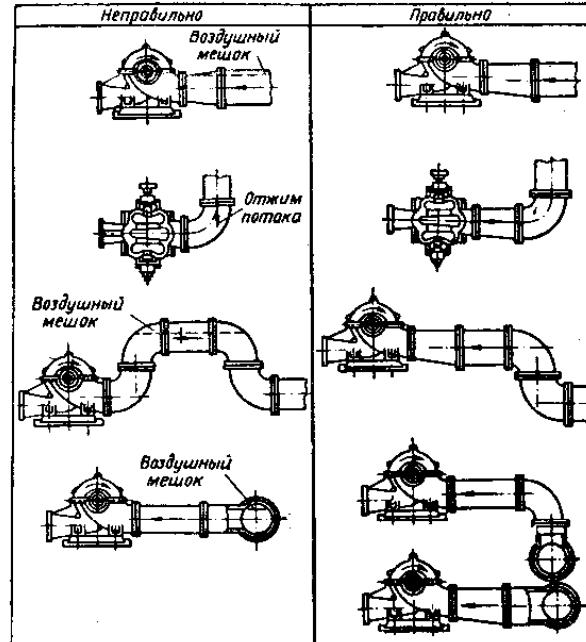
Присоединения всасывающего трубопровода к насосу.
